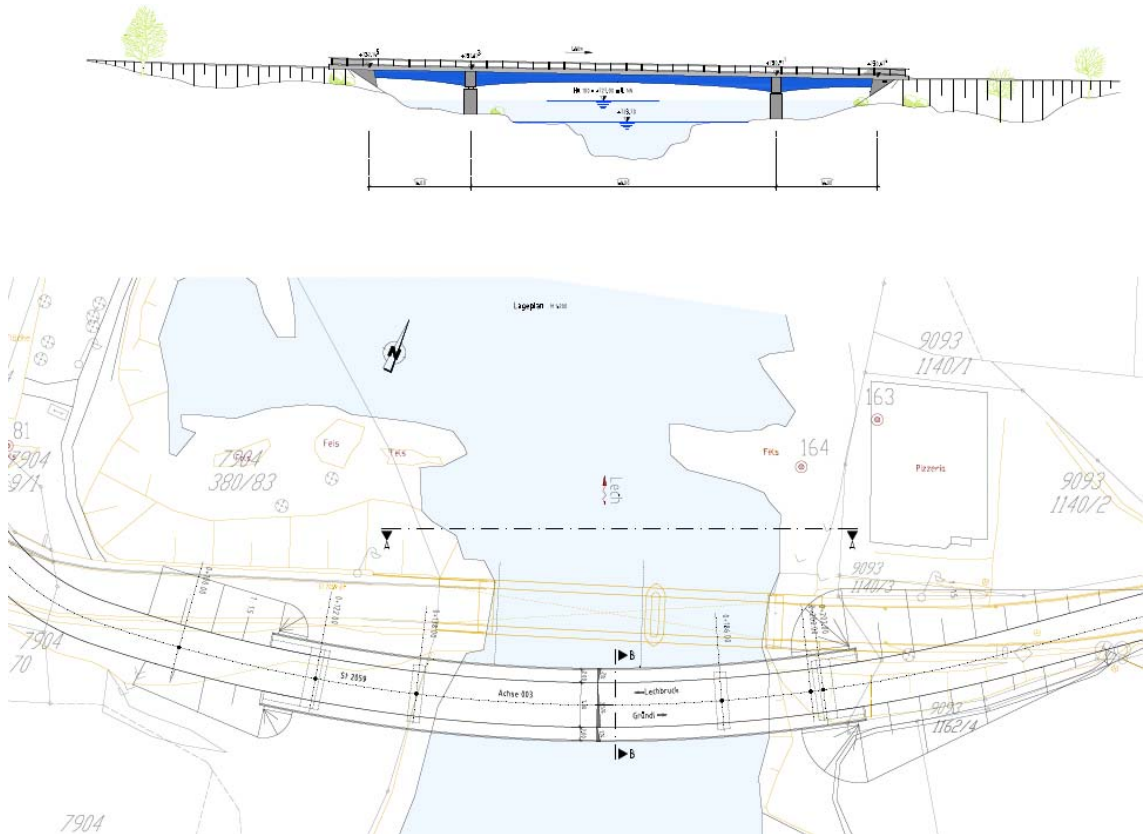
Variante 6 in Grundriss und Ansicht
